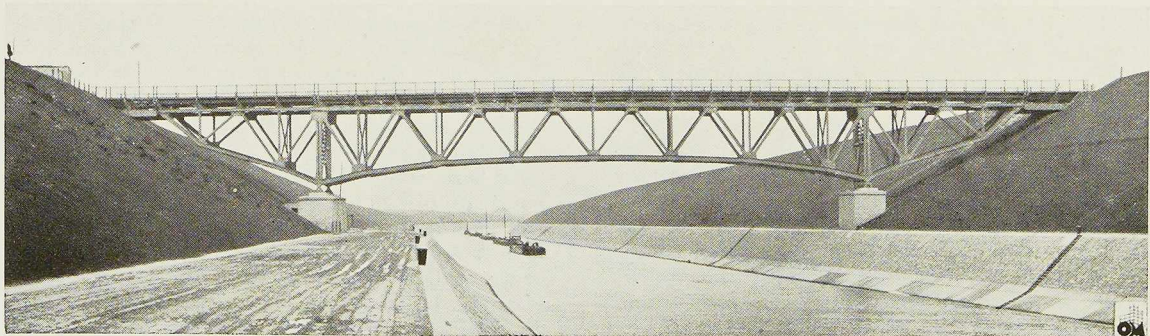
Pont de Veldwezelt à poutres principales sous chaussée.
